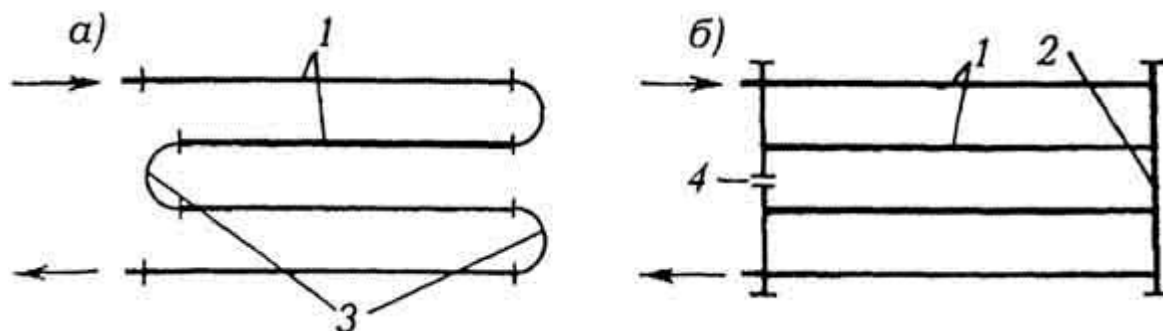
Формы соединения труб в гладкотрубных отопительных приборах: а - змеевикоподобная форма; б - регистровая форма; 1 - нитки; 2 - колонка; 3 - калачи; 4 - заглушка
